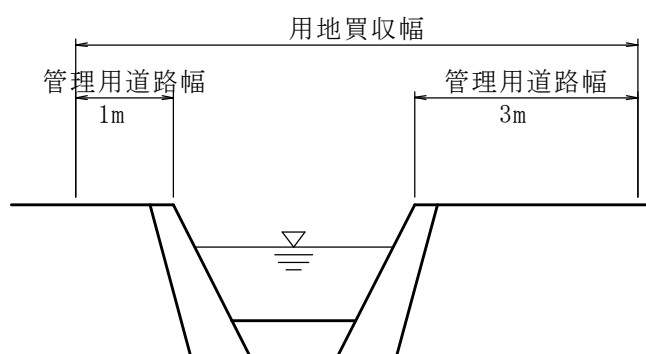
溪流保全工（一般部）の用地買収範囲
